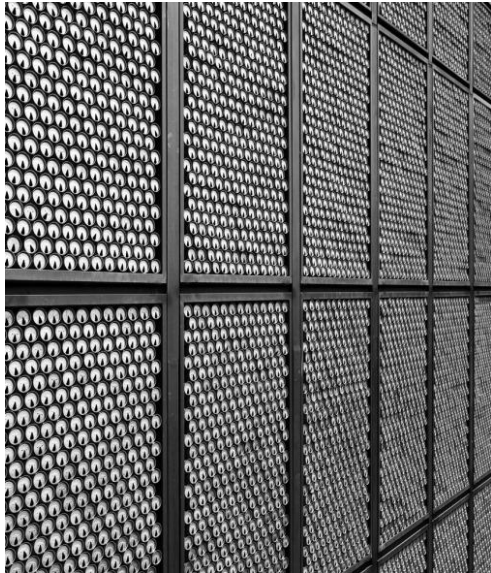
Sistema de fachada de latas de aluminio Can Cube. Fuente.
